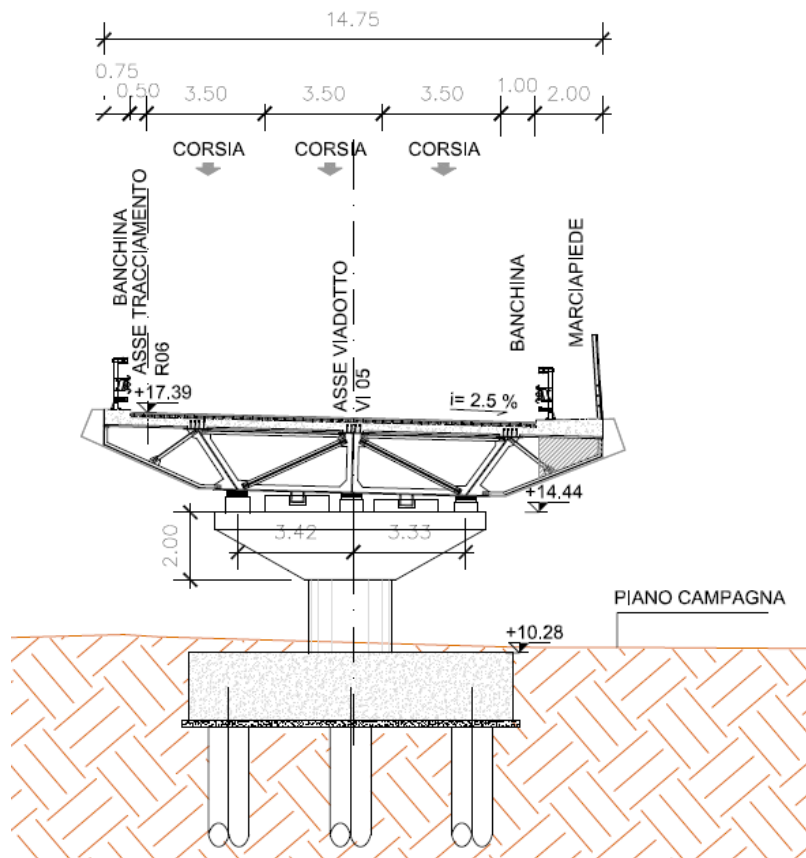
Viadotto V105 - Sezione trasversale su pila
